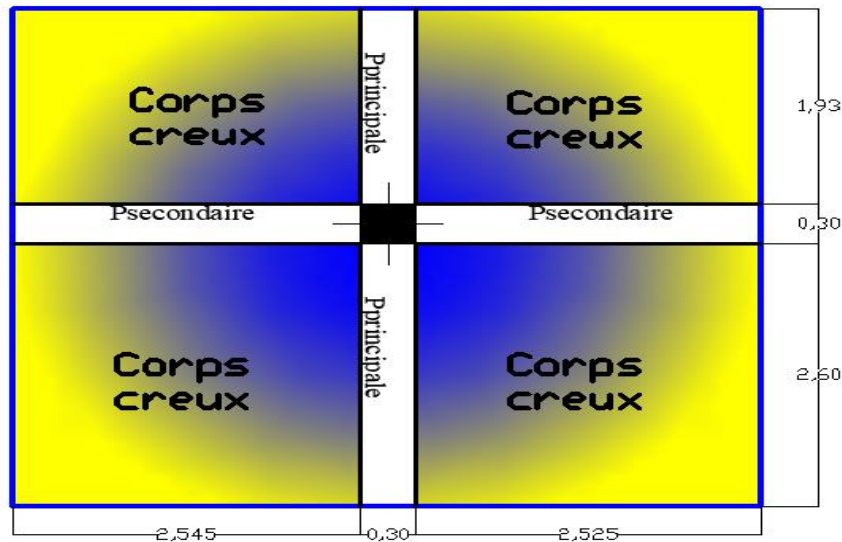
Surface du poteau (P2) du RDC à la terrasse inaccessible
